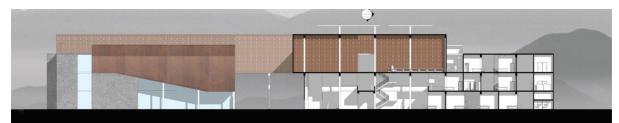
Corte 1 mercado Mayorista. Elaboración propia
